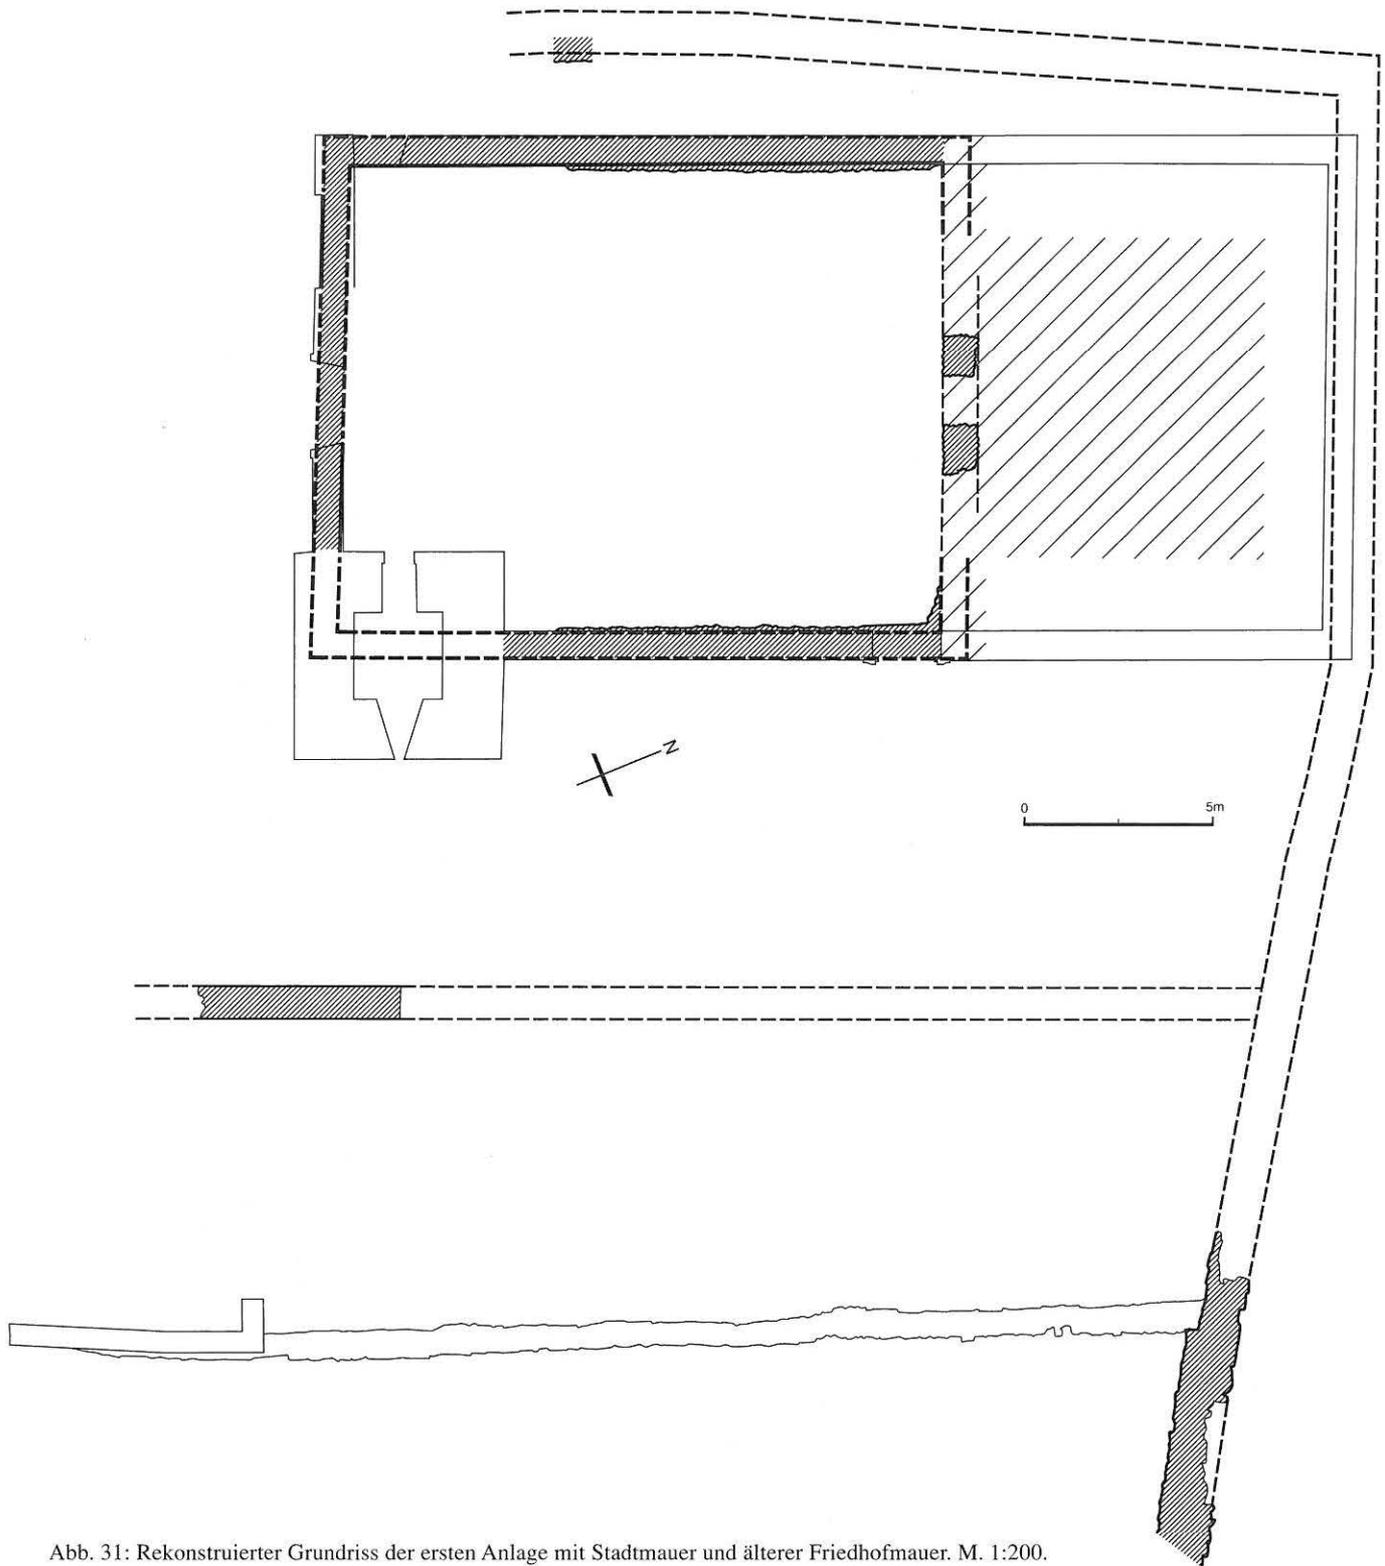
Rekonstruierter Grundriss der ersten Anlage mit Stadtmauer und älterer Friedhofmauer. M. 1:200.
